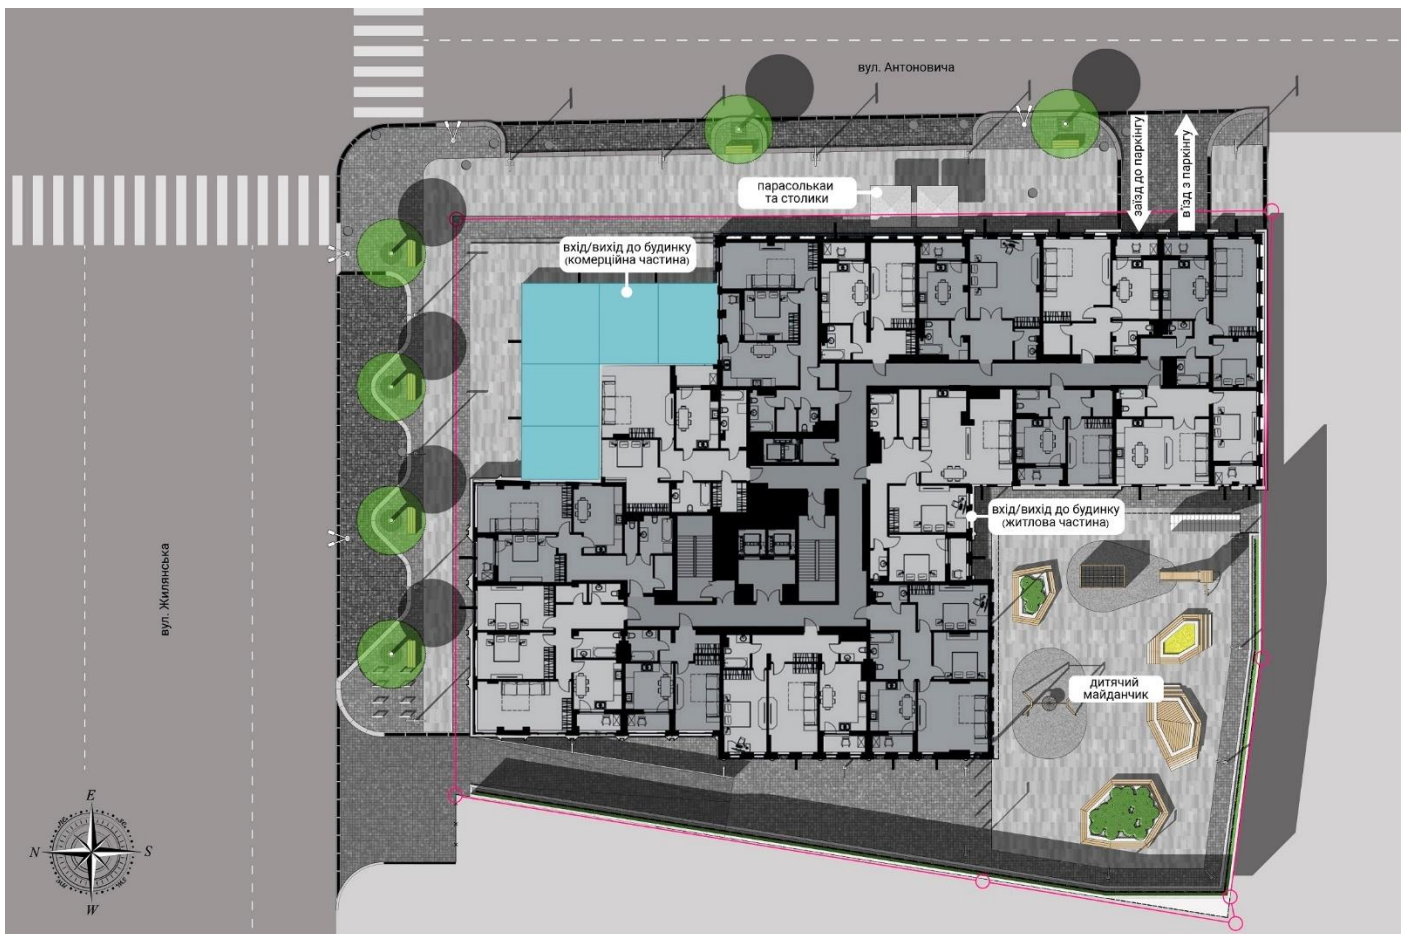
Генеральний план житлового комплексу Chicago central house
